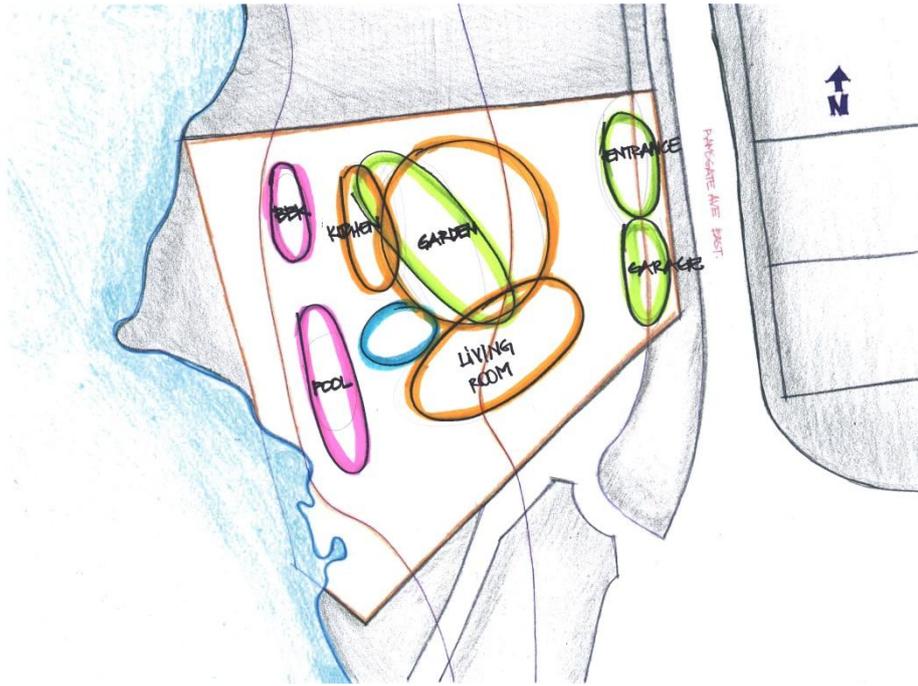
Croqui do estudo inicial de massas para a residencia, pavimento térreo.
